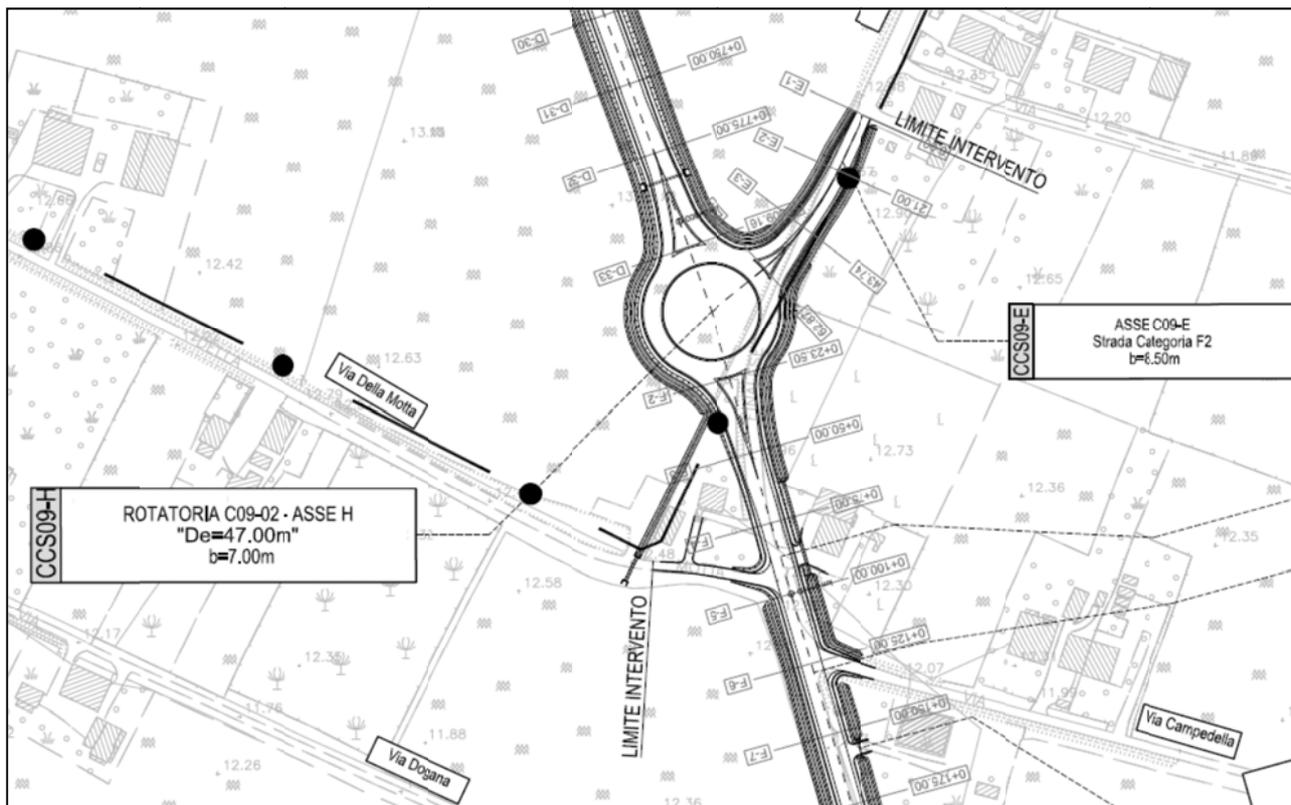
STRALCIO PLANIMETRICO PD DELLA ROTATORIA C09-R2
